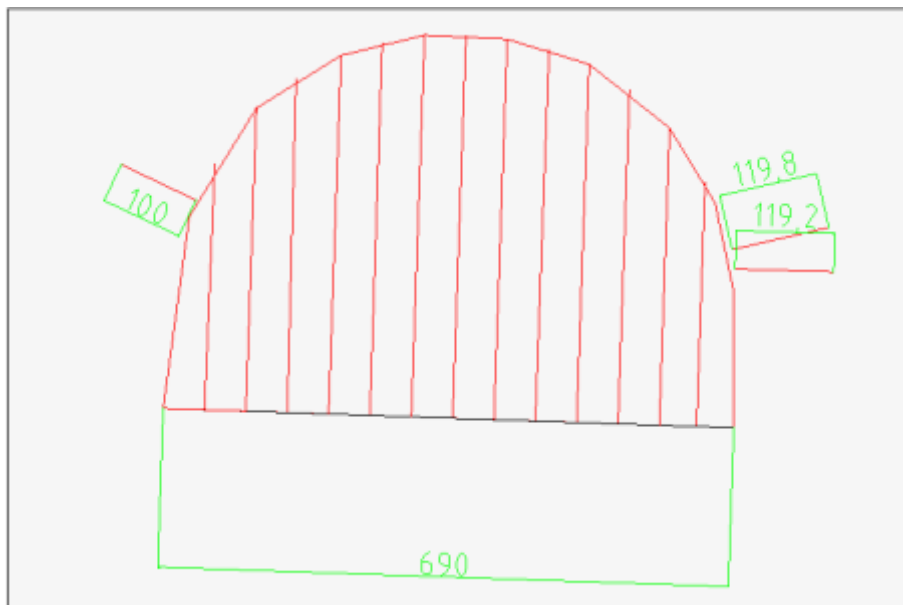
Digitalización de las medidas para la elaboración del plano
